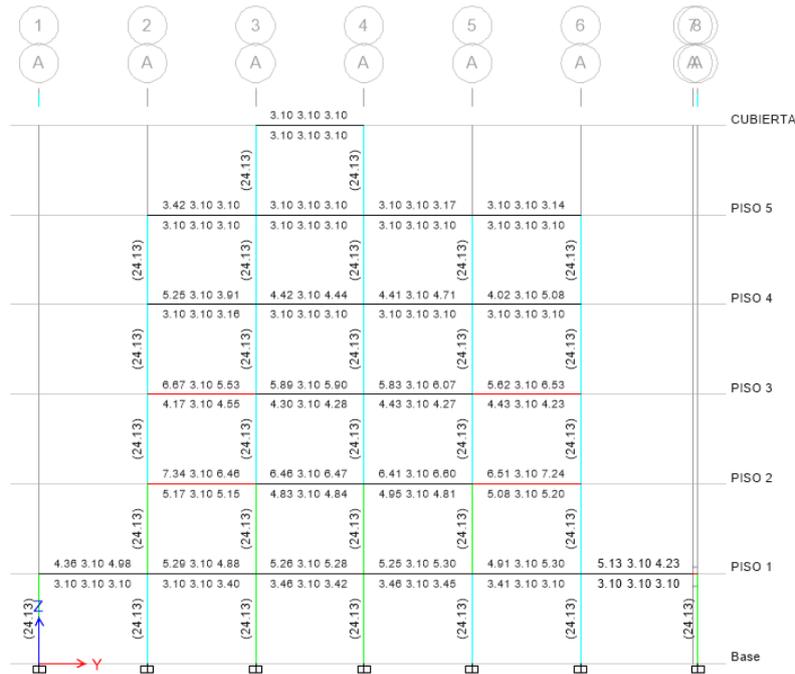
Detalles calculados por ETABS 19 de columna de 45x45.
